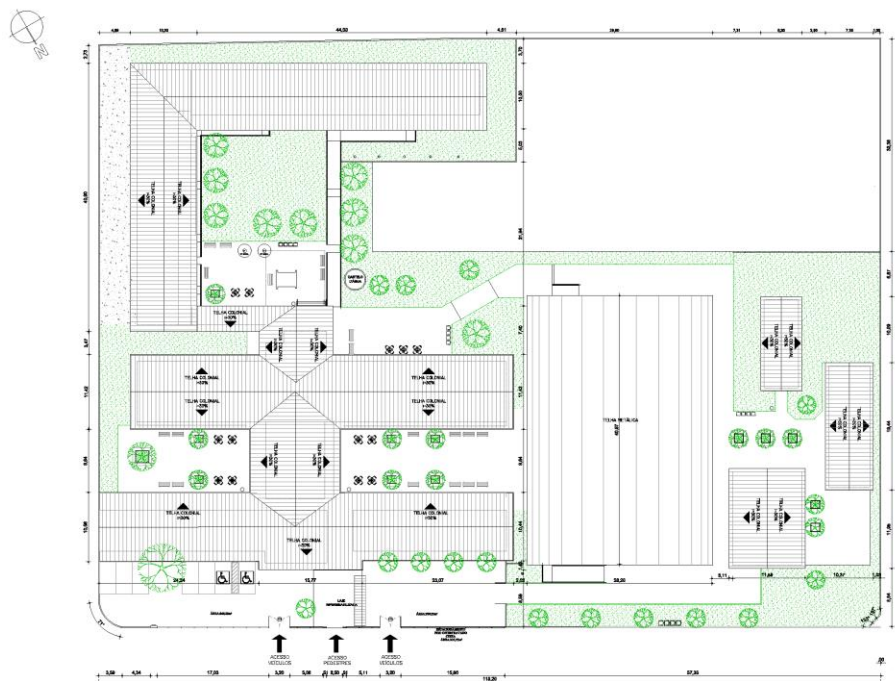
Planta de Implantação. Fonte: SEINF-COPROJ.
